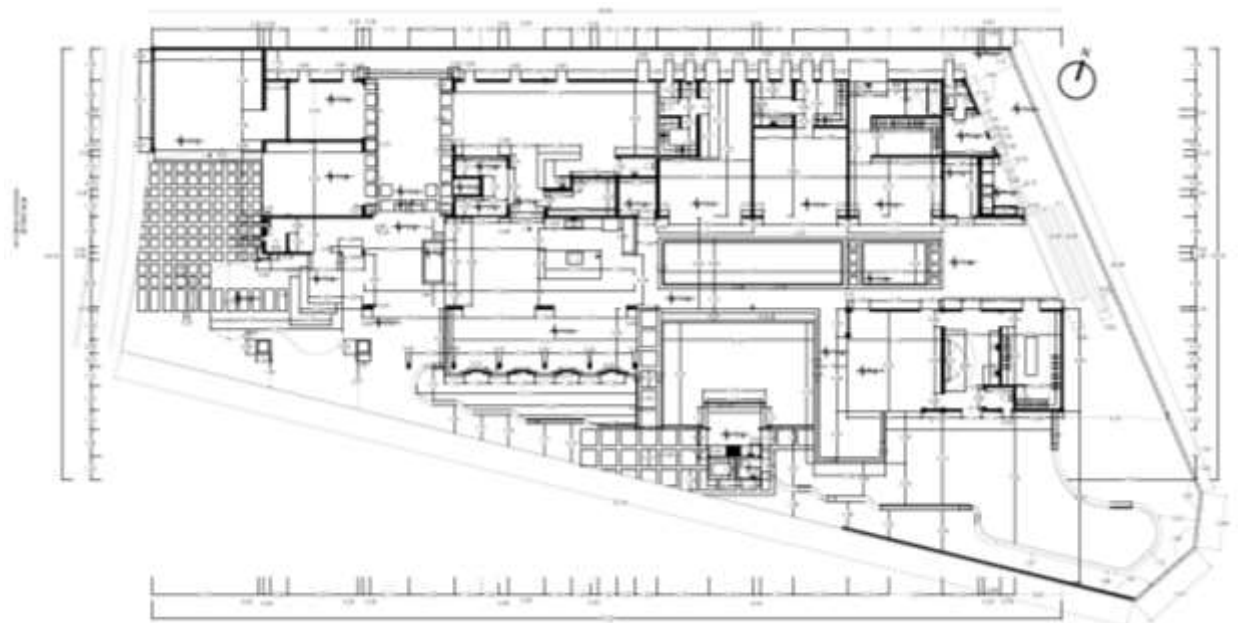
Planos eléctricos del primer y segundo nivel
